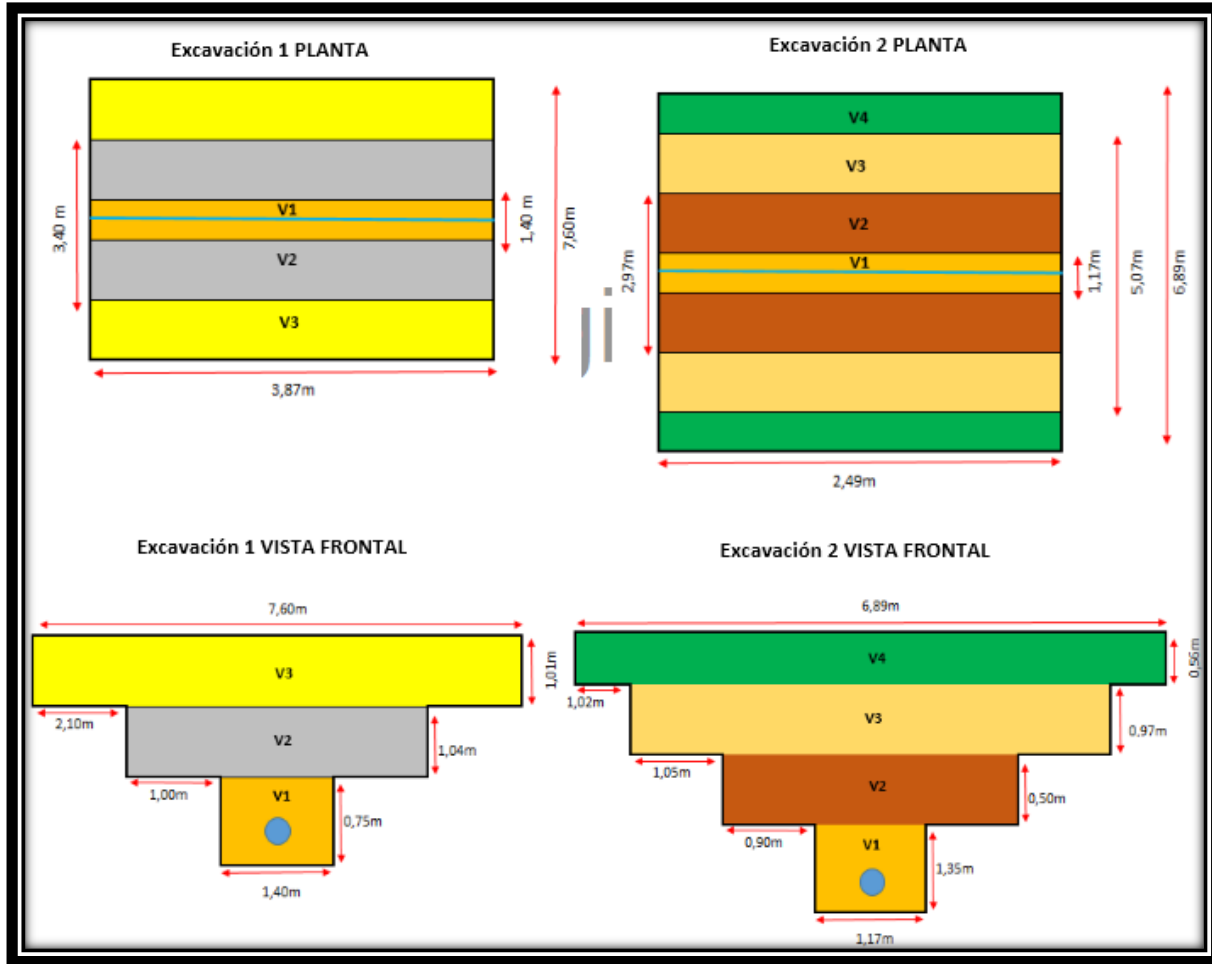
Informe de Registro de Excavación. Edgar Fierro.
